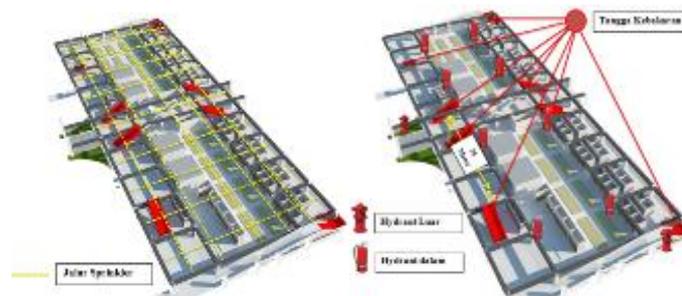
Desain Bentuk Dan Tampilan Bangunan
